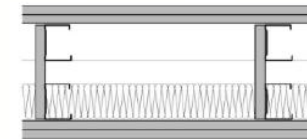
Colocação da lâ de rocha em paredes com dupla estrutura ligada – fonte: Manual de projeto e sistemas de drywall – Fonte: Associação Drywall
